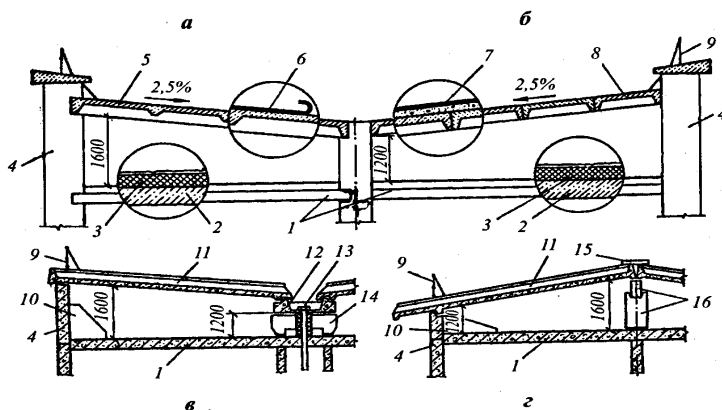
Конструктивные схемы железобетонных крыш с холодным чердаком:
